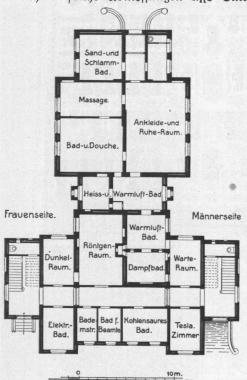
Allgemeines Krankenhaus Hamburgs Eppendorf, Badehaus, Grundriß.
